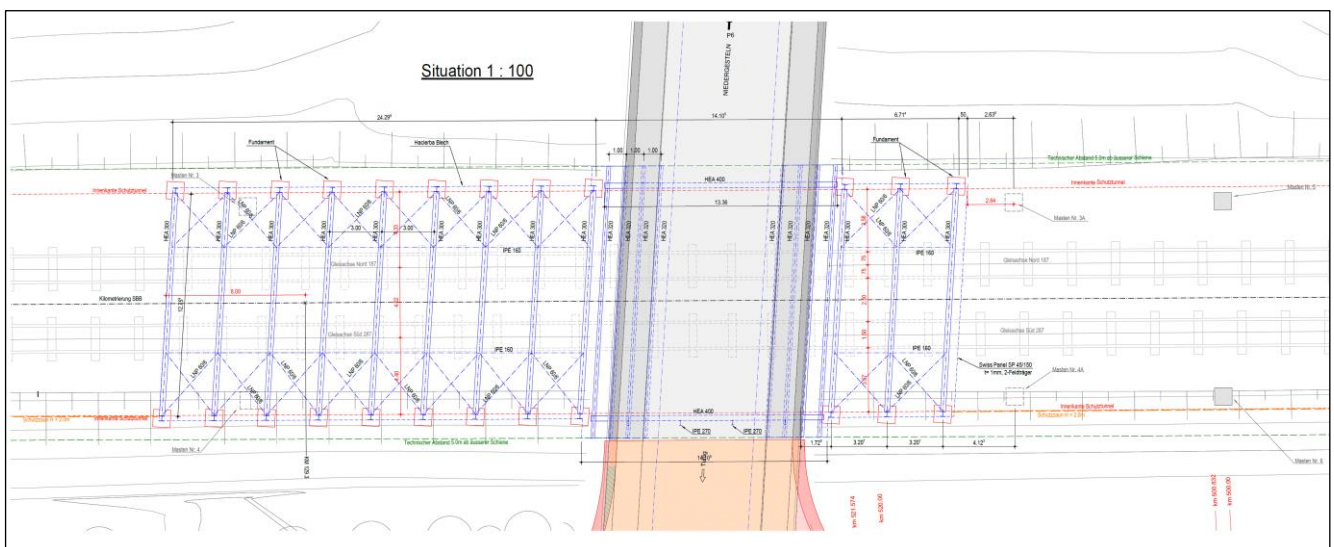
Schutztunnel im Querungsbereich best. Überführung Turtig mit SBB-Trasse, Grundriss
